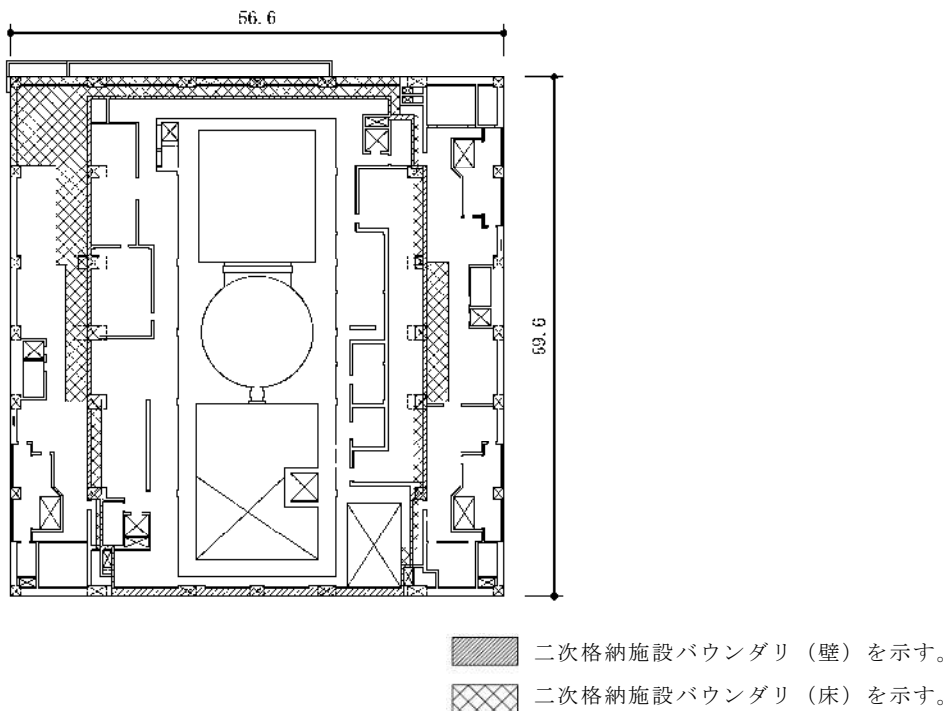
原子炉建屋原子炉区域（二次格納施設）の範囲の平面図（単位：m）
